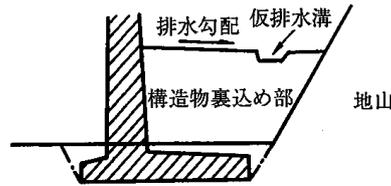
施工中の構造物裏込め部の排水処理の例³⁾
